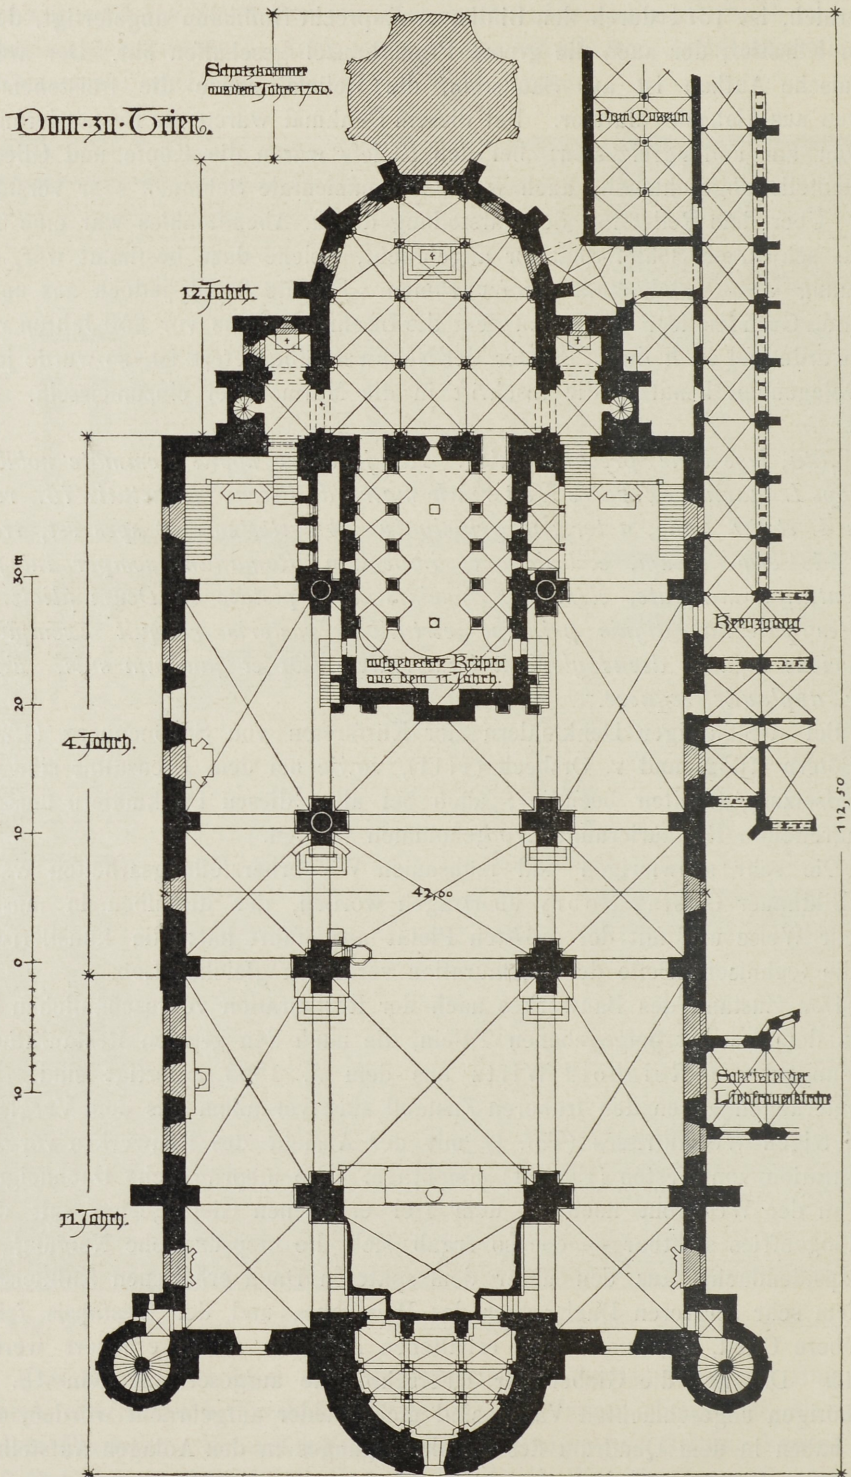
Trier. Grundriss des Domes mit den drei Krypten.
